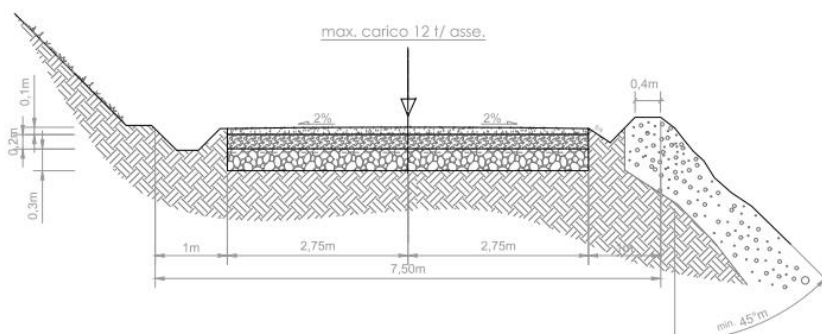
Sezione stradale tipo con scarpata (mezza costa)
